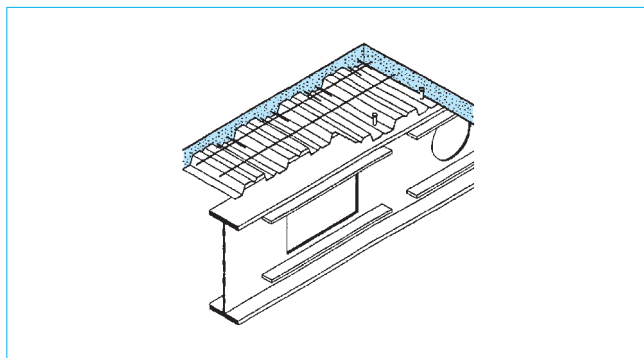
Dalle mixte connectée à une poutrelle à âme ajourée
